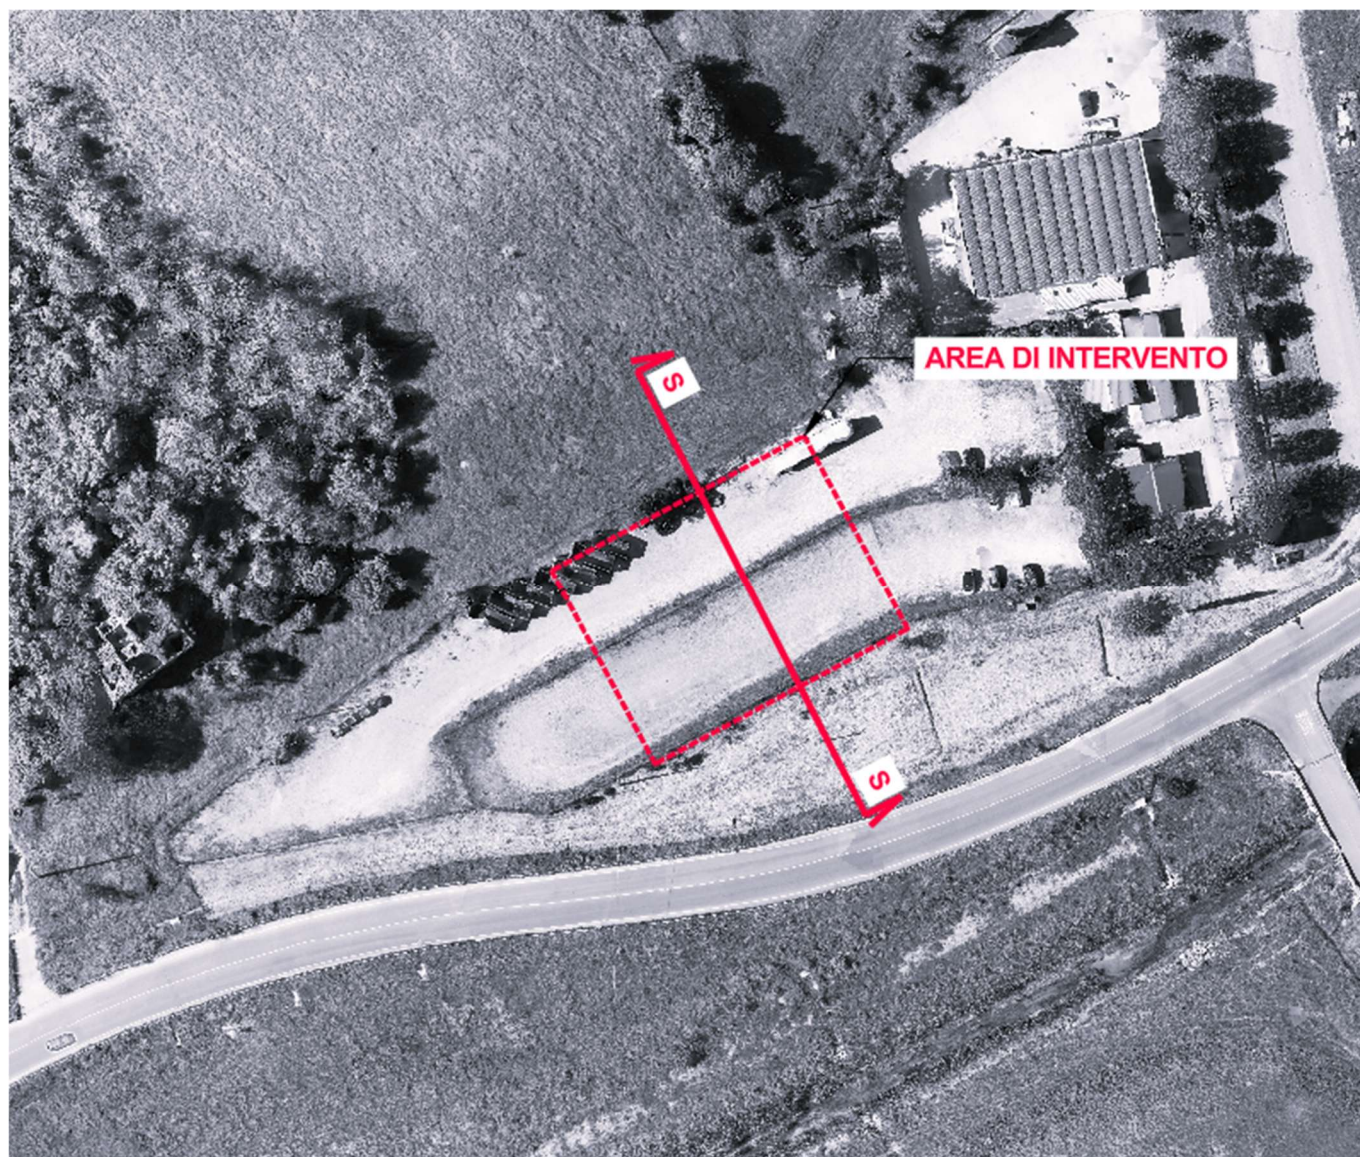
Planimetria con indicazione dell'area di intervento e della sezione stratigrafica
